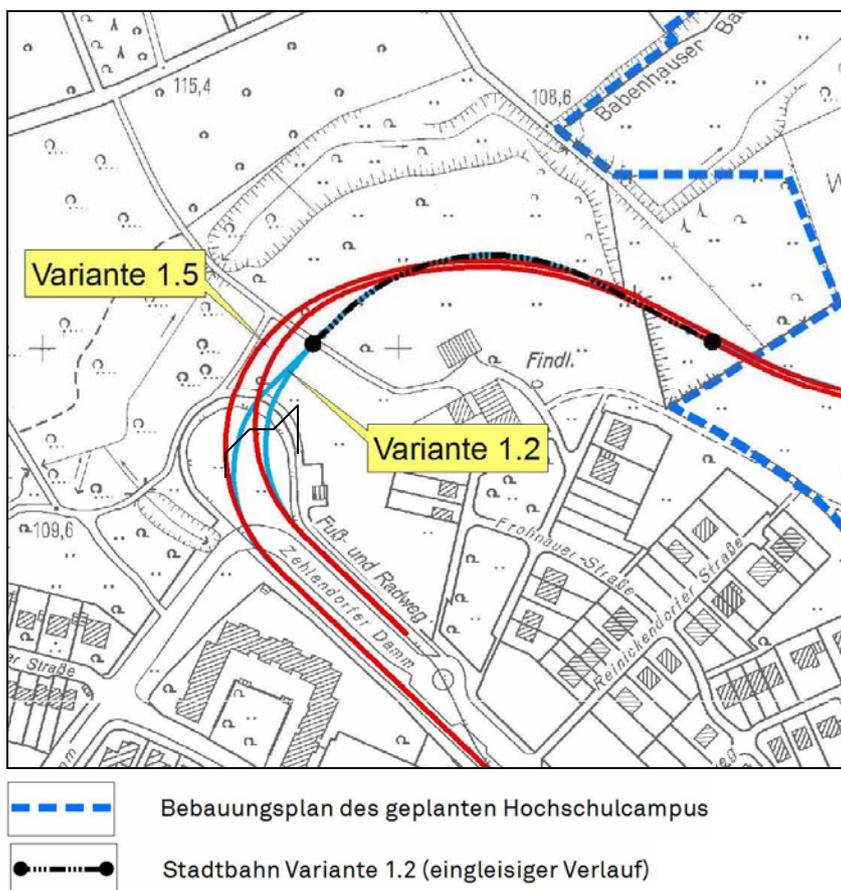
Vorzugsvariante 1.2 und zweigleisige Trassenführung der Variante 1.5 im Bereich Zehendorf-Damm/Wohngebiet Hof Hallau (eingleisiger Abschnitt als gestrichelte Linie)
